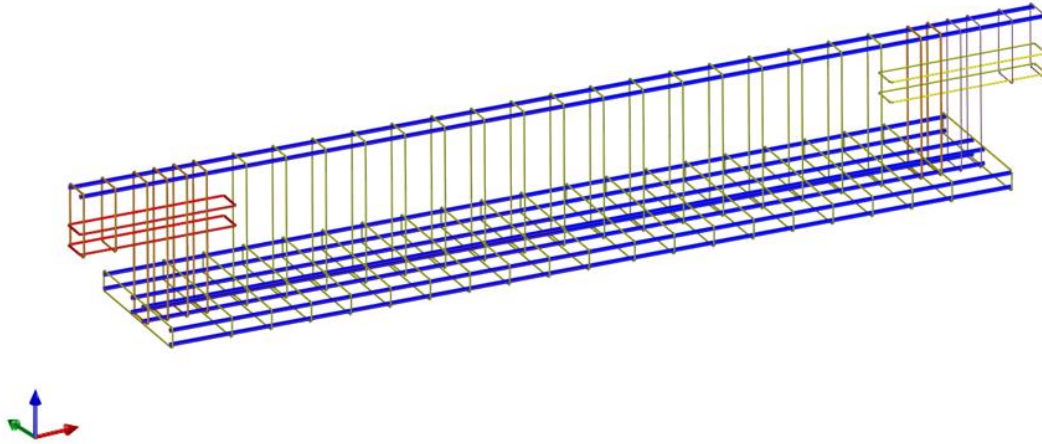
Modello geometrico armature, trave schema A, vista 3D
